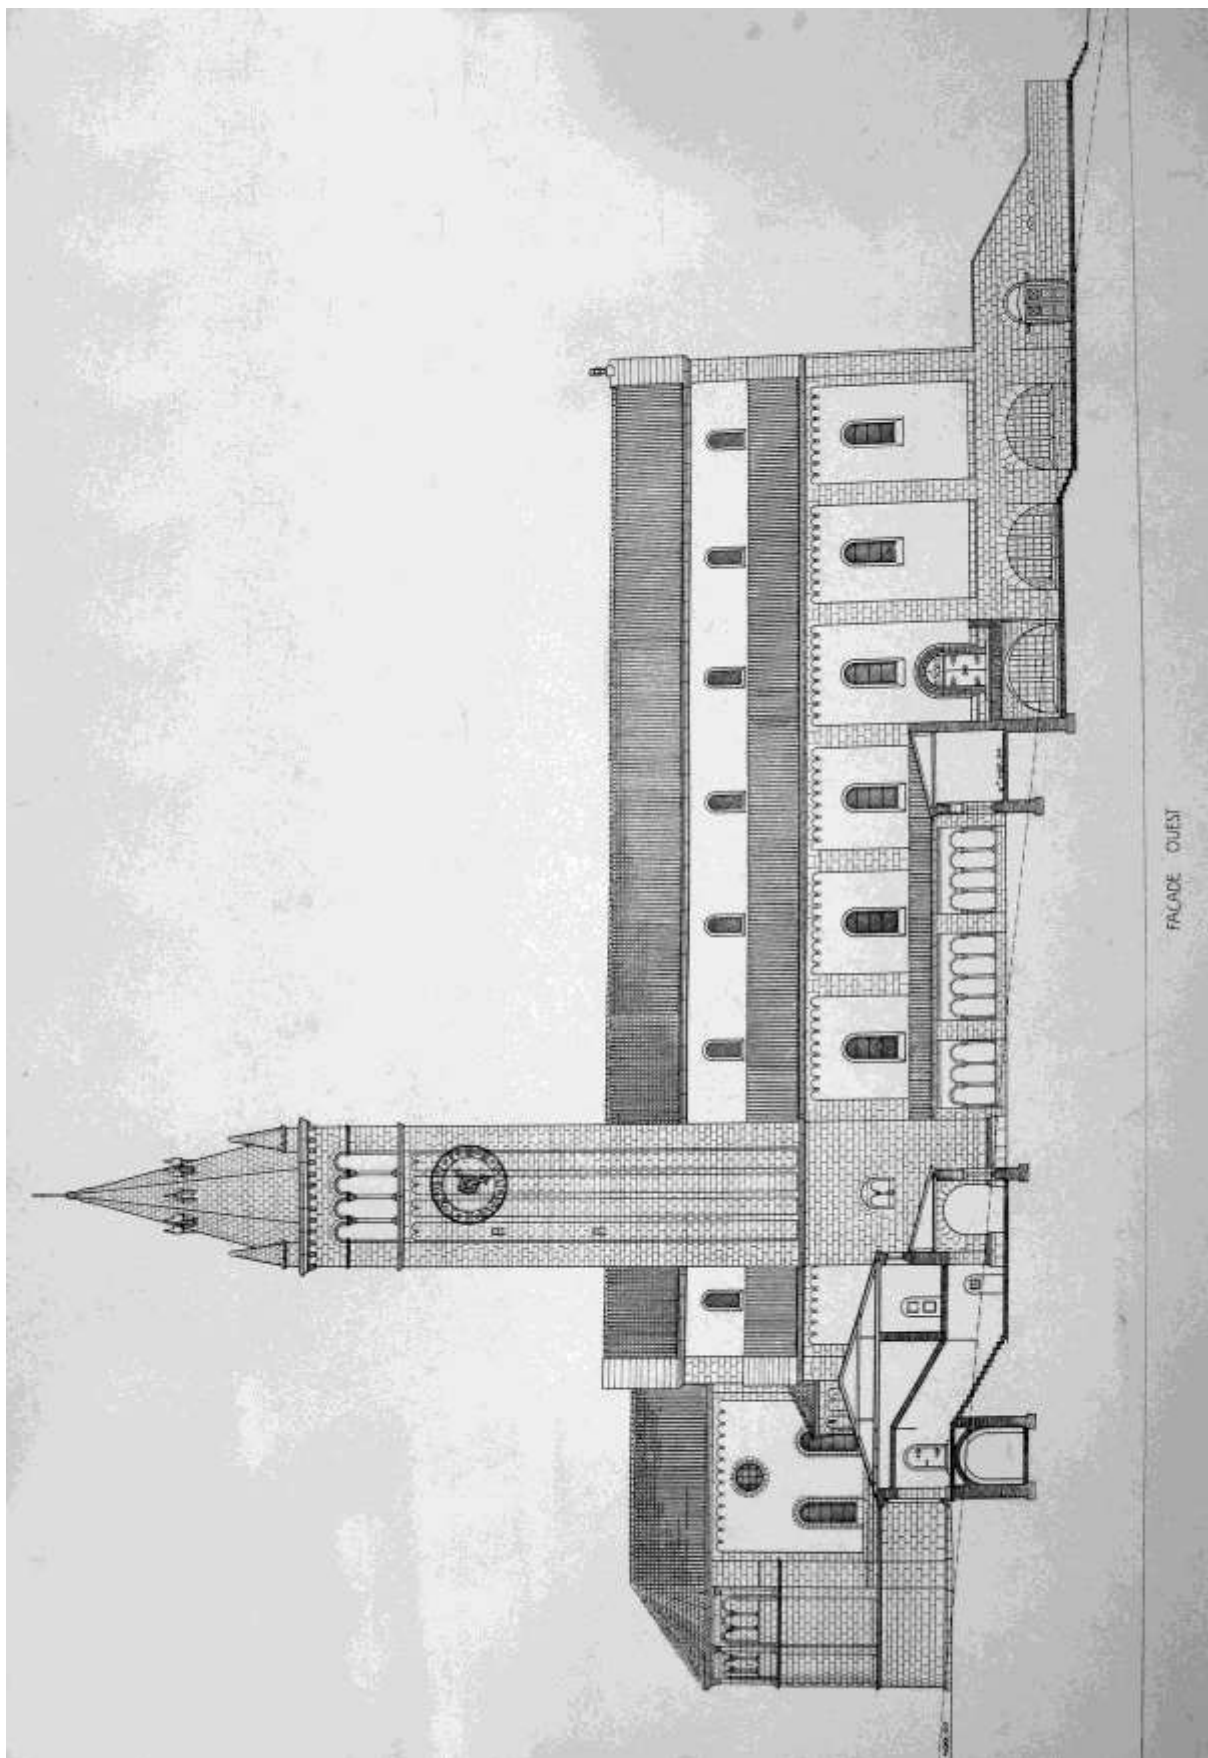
Plans d'exécution, élévation Ouest, Otto Schmid et Willy Meyer architectes, 1915 (ACV PP 4/5).
